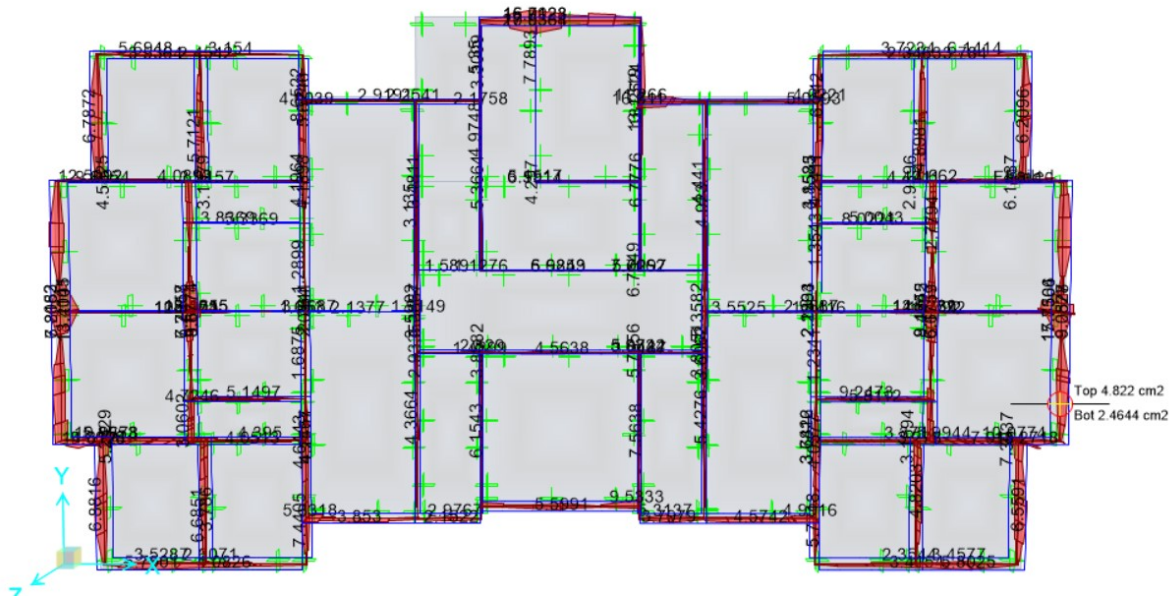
Distribución de acero longitudinal en vigas de cimentación Sistema MDL - Edificio Blesser. Fuente: Elaboración Propia.
